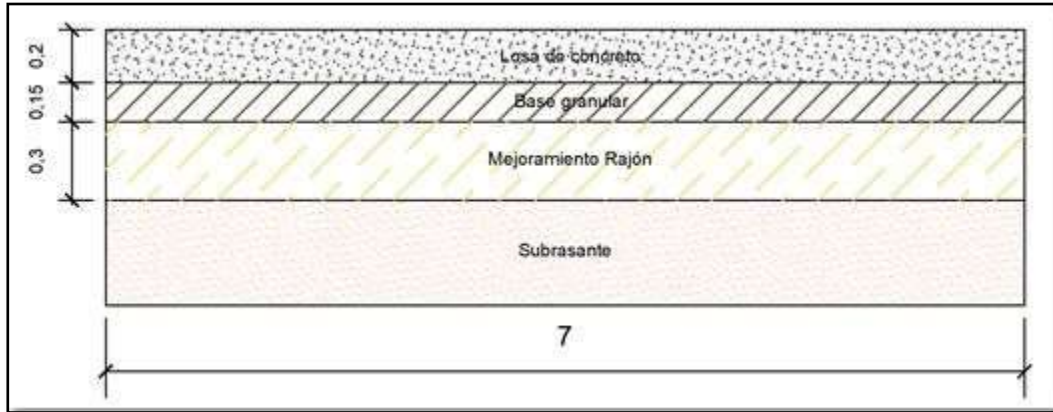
Estructura de Pavimento Rígido – Metodología AASHTO (Sin Berma)
